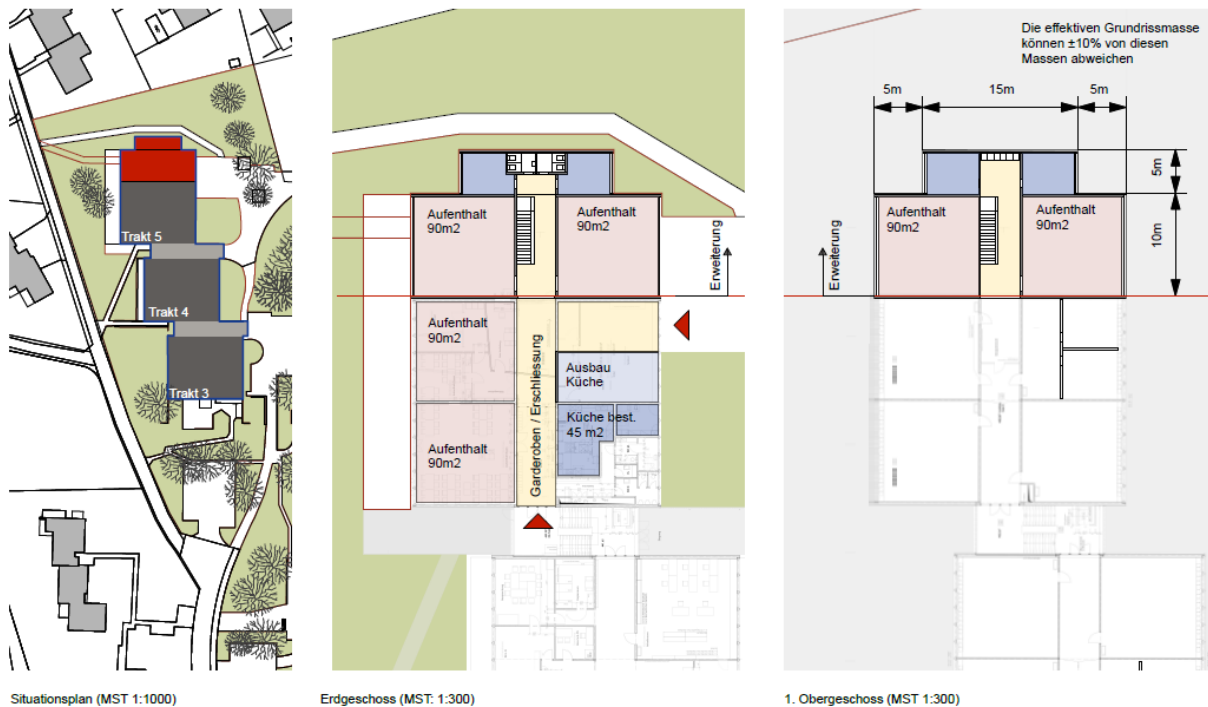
Bausteine A und B, Sanierung Trakte 3–5 und Horterweiterung (Grundrisse Erd- und Obergeschoss)
